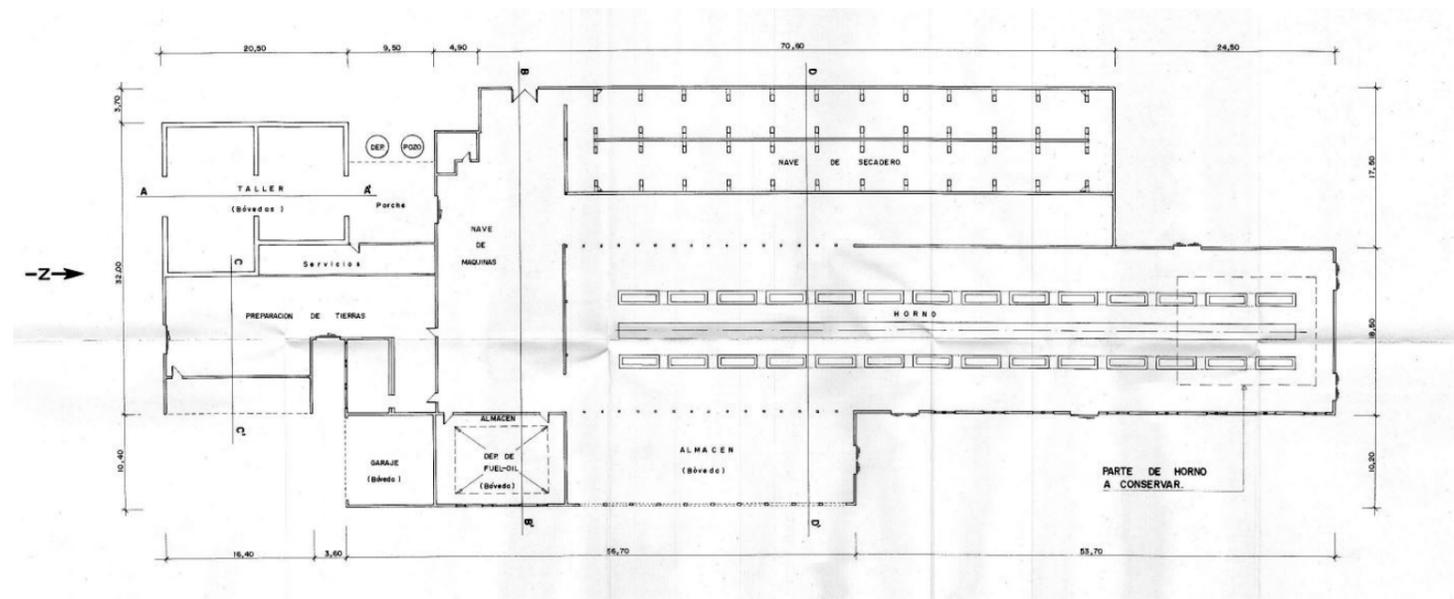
Planta baja de Cermag en 1986, escala 1:200
